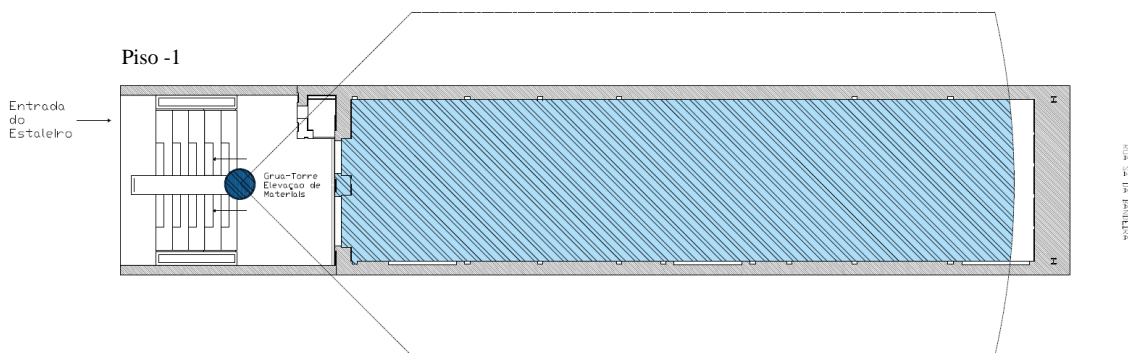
Planta do estaleiro da obra Sá da Bandeira na 1ª Fase
